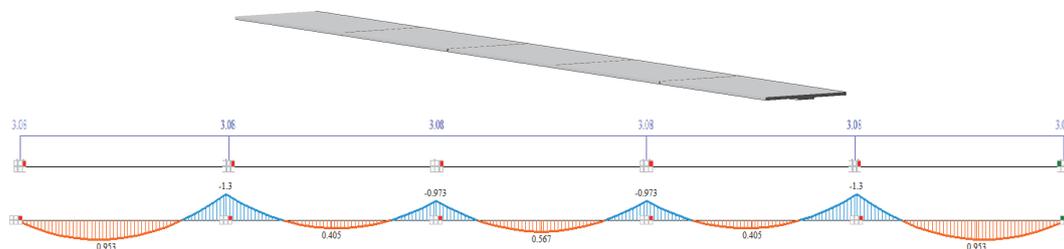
Многопролетная неразрезная балка, расчетная схема и эпюра изгибающих моментов
